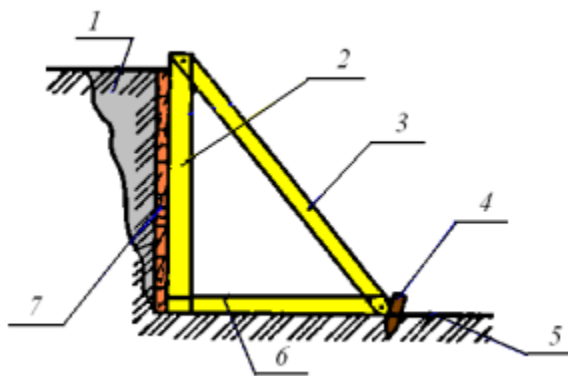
Подкосное крепление стенок выемок: 1 – полость, засыпаемая землей; 2 – стойка; 3 – подкос; 4 – клин-анкер; 5 – дно котлована; 6 – распорка; 7 – щит забирки
